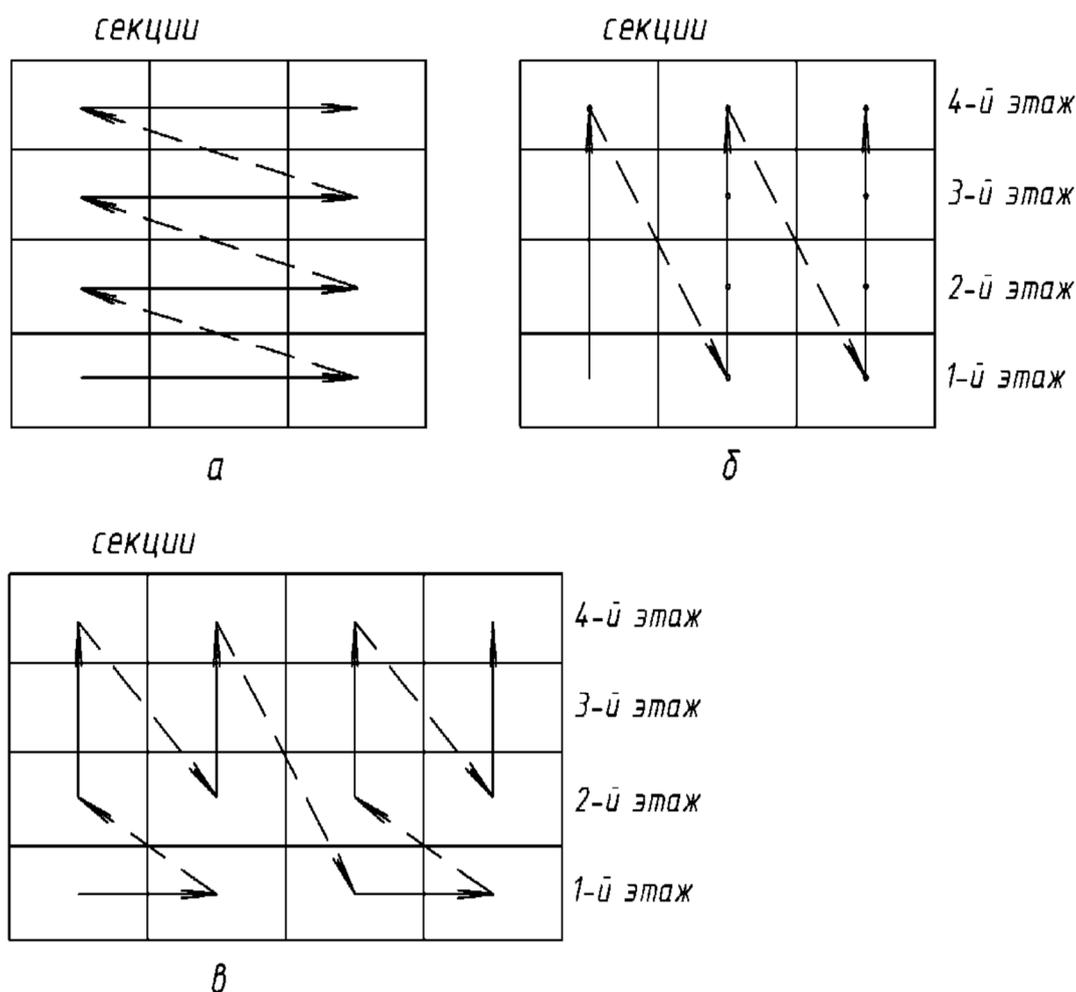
Схемы направления монтажа многоэтажных зданий:
